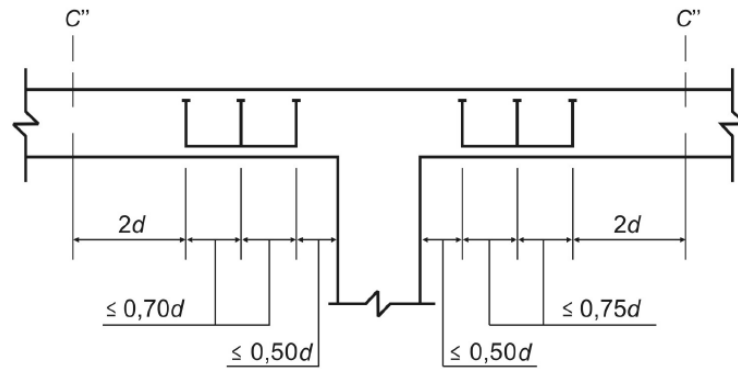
Disposição da armadura de punção em corte segundo a NBR 6118:2003
